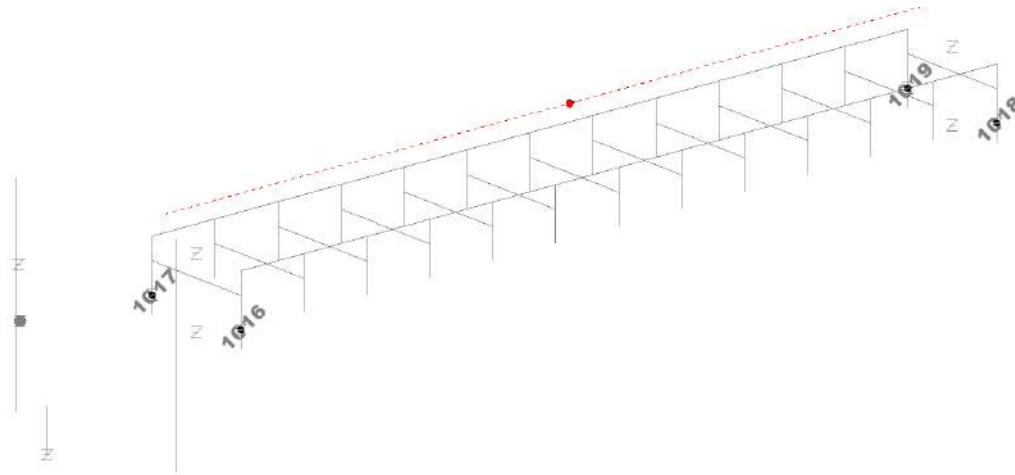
Mappa elementi joints appoggi Spalle
